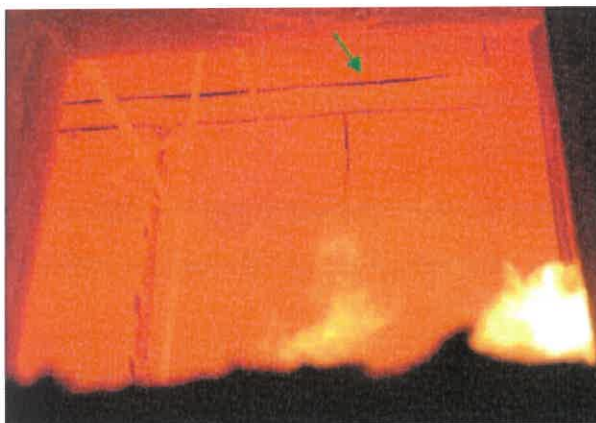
Prüfminute 60: Erste Plattenlage löst sich an den Vertikalfugen. Horizontale Bekleidung des Deckenanschlusses löst sich weiter.
